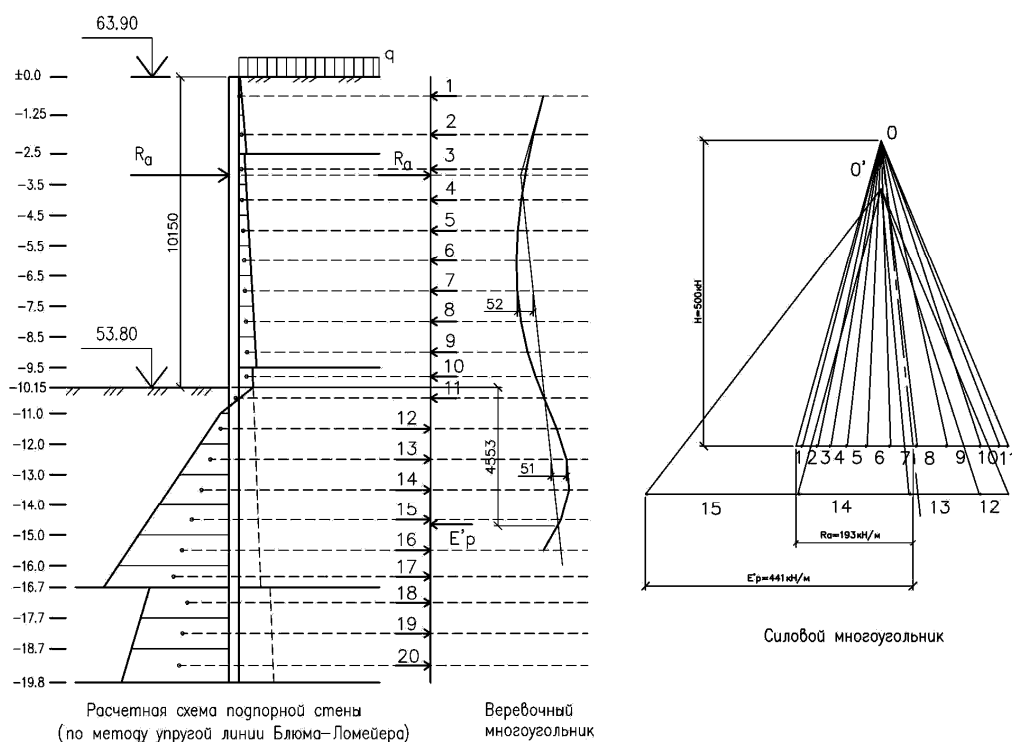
Схема к расчету ограждения котлована с распоркой после полной разработки грунта
